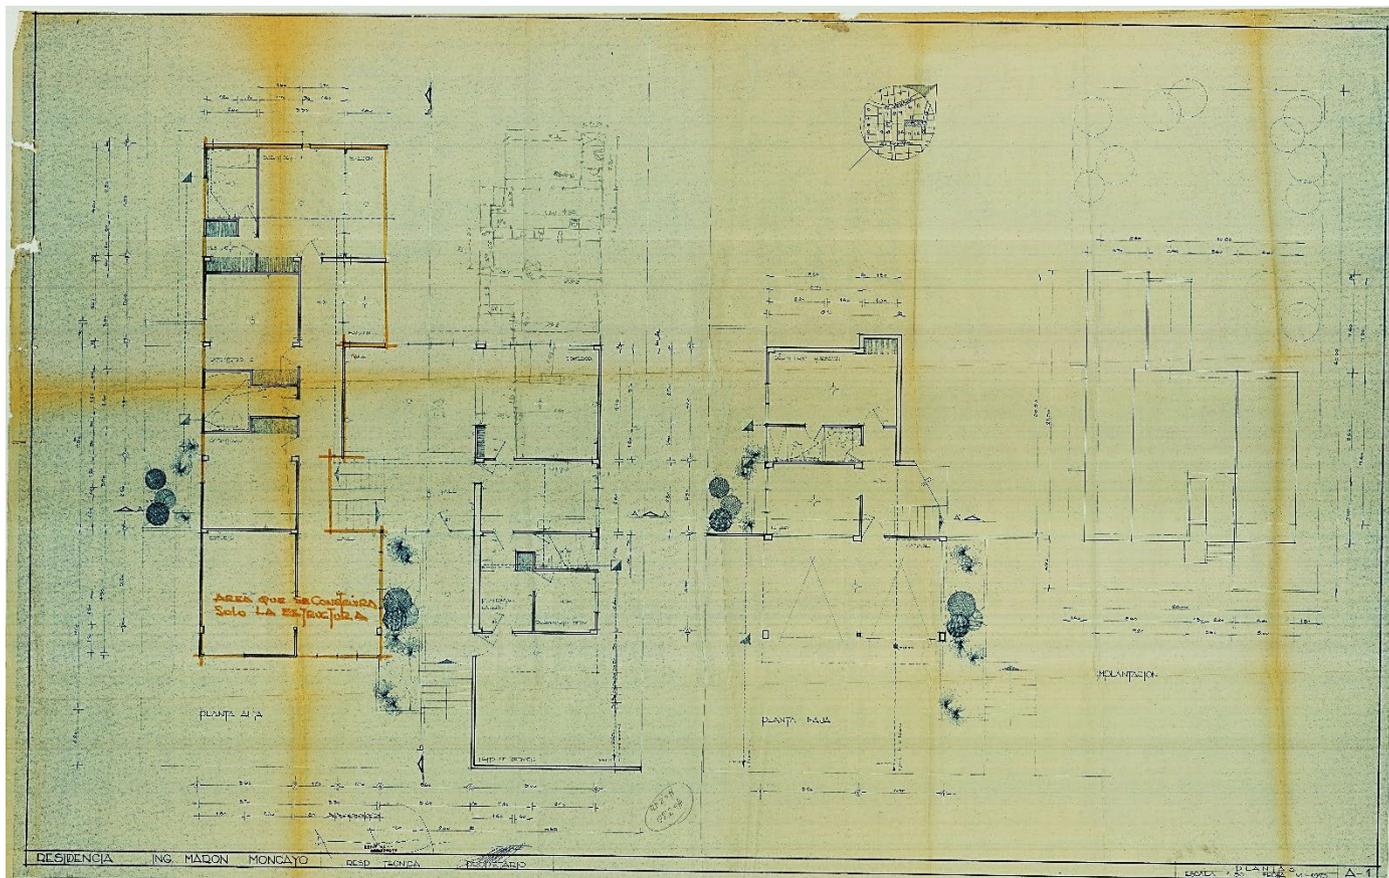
Planos originales de casa Moncayo, año 1974. Archivo René Bravo Rubira
